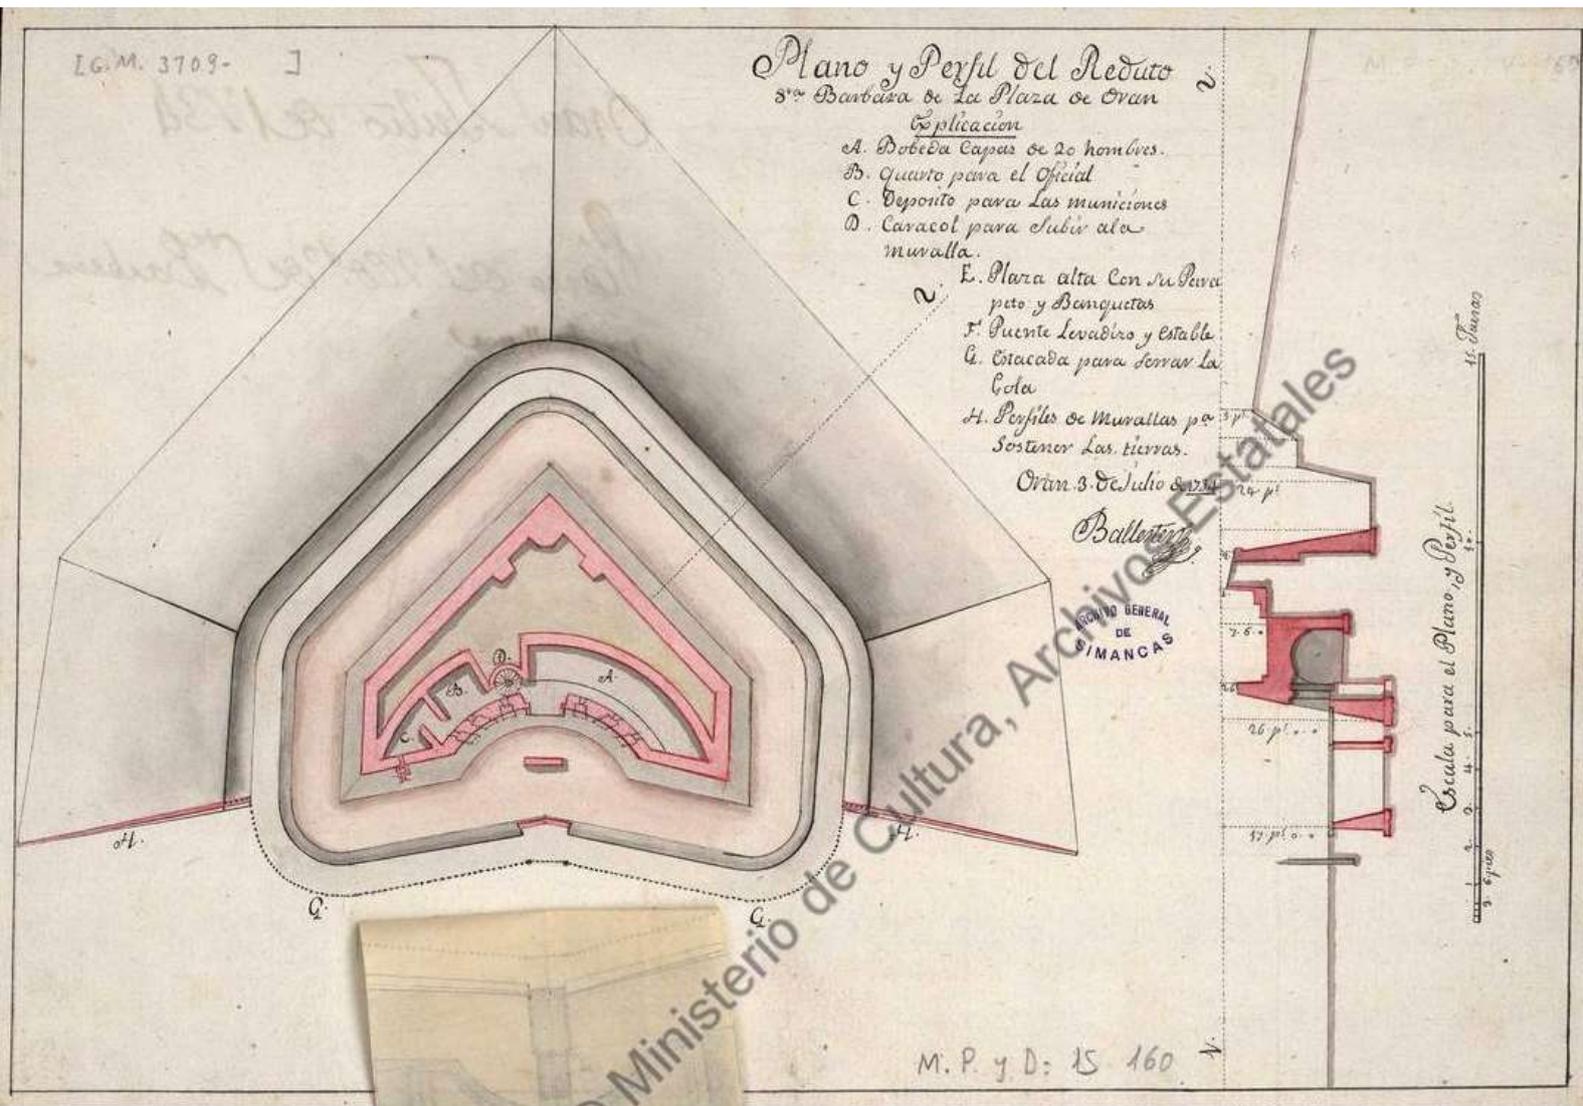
Plano de Santa Bárbara en 1734 del ingeniero Juan Ballester. (AGS, GyM, Leg.037091, MPD, 15, 160).
